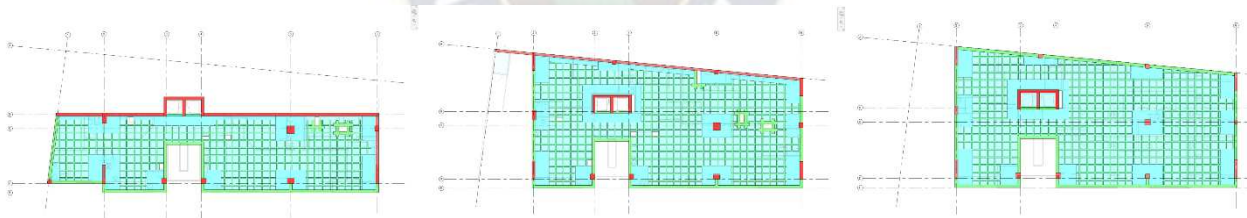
Vigas y losas - Nivel 1, Nivel 3 y Nivel 10 - Fuente: Elaboración propia
